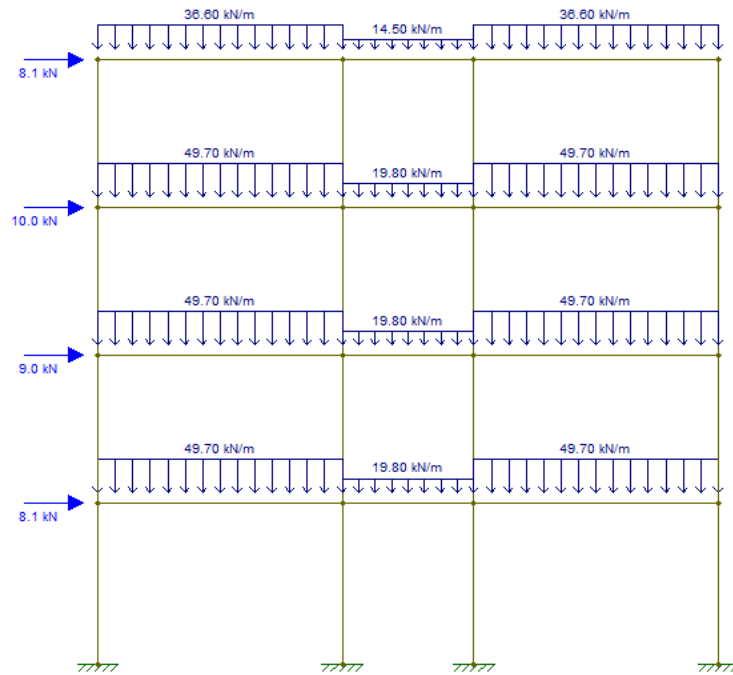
Pórtico 6 carregado, vigas V6 e V9
